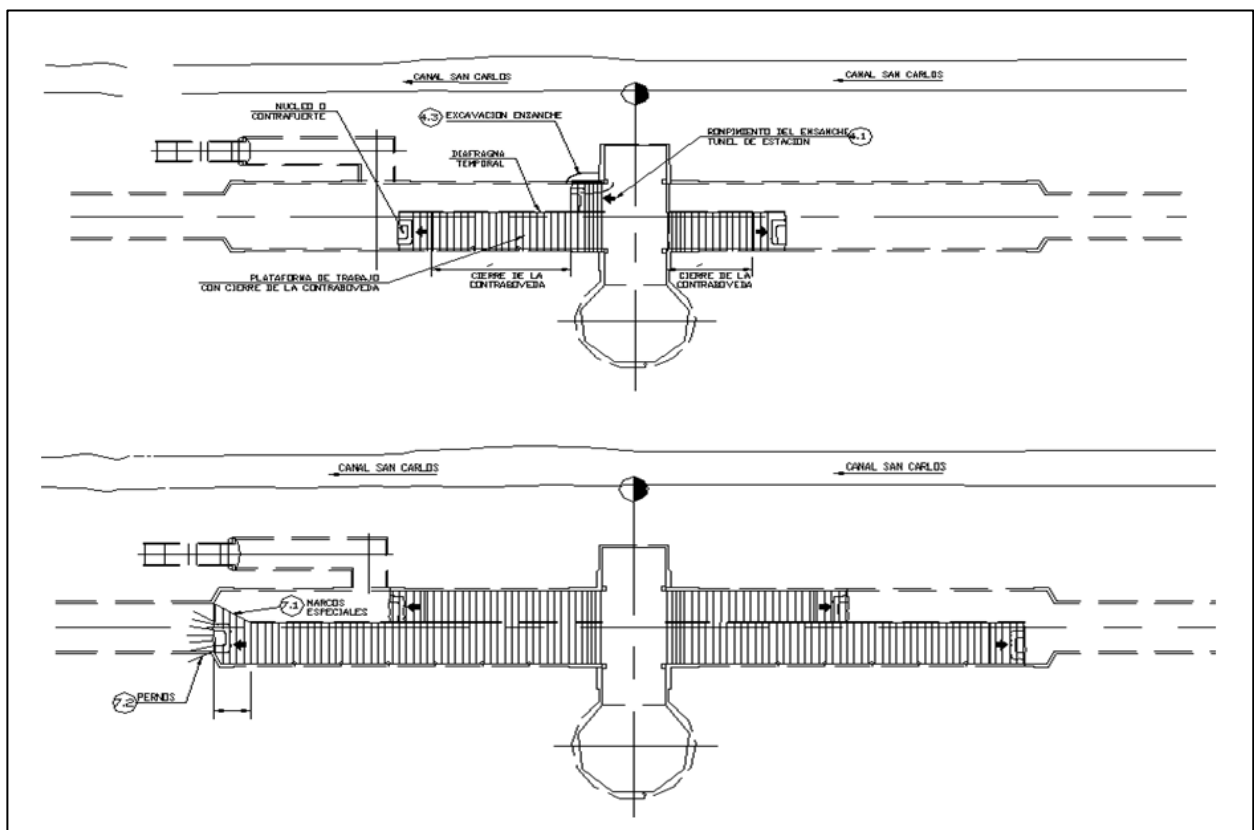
Vista en planta de secuencia de excavación de un túnel con side-drift.
